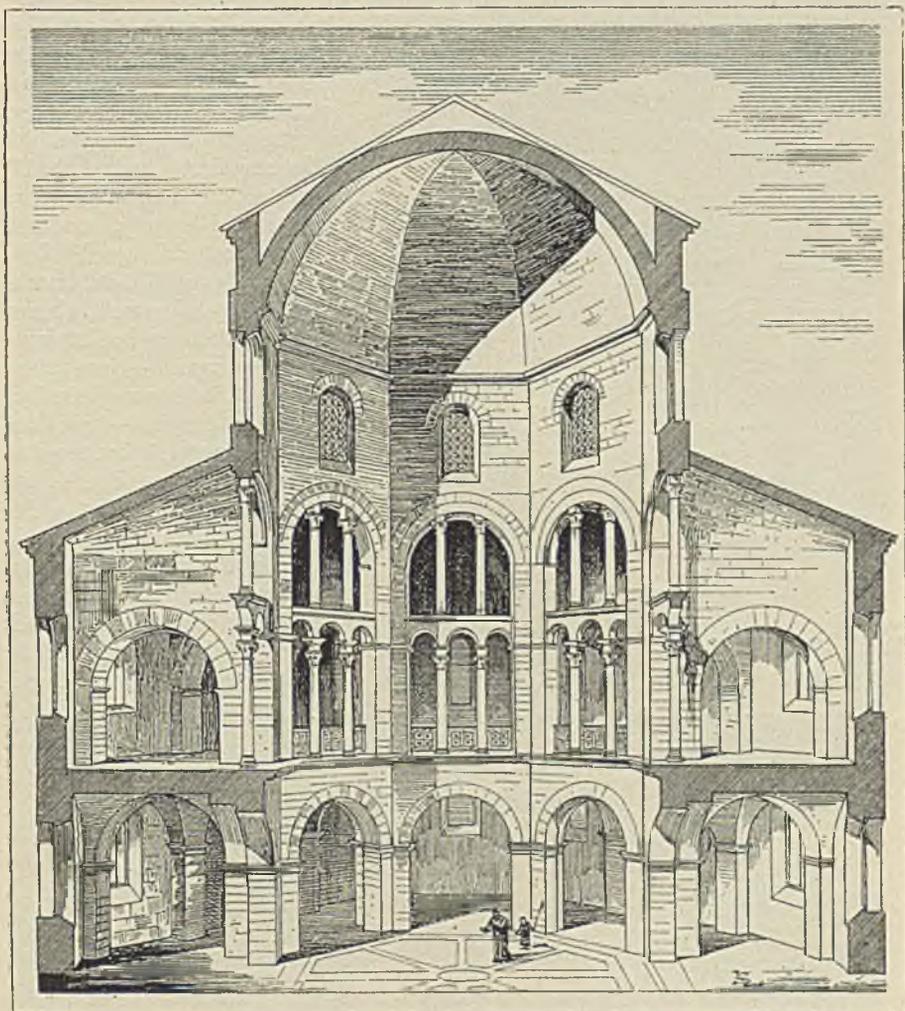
Durchschnitt des Münsters zu Aachen (rekonstruiert)
